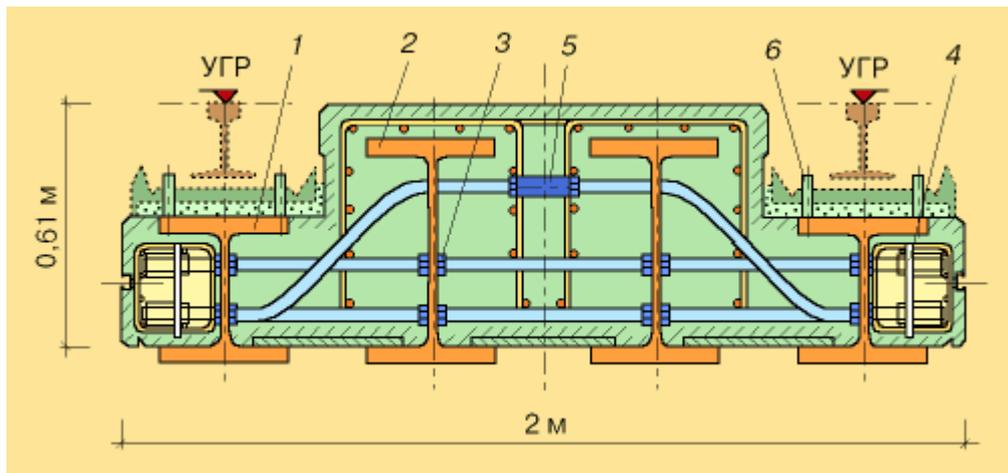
Поперечное сечение пролетного строения: 1 – боковая балка; 2 – центральная балка; 3 – винтовое соединение поперечной арматуры; 4 – анкерная плита; 5 – муфта, соединяющая косые армирующие элементы; 6 – приварные болты [77]
